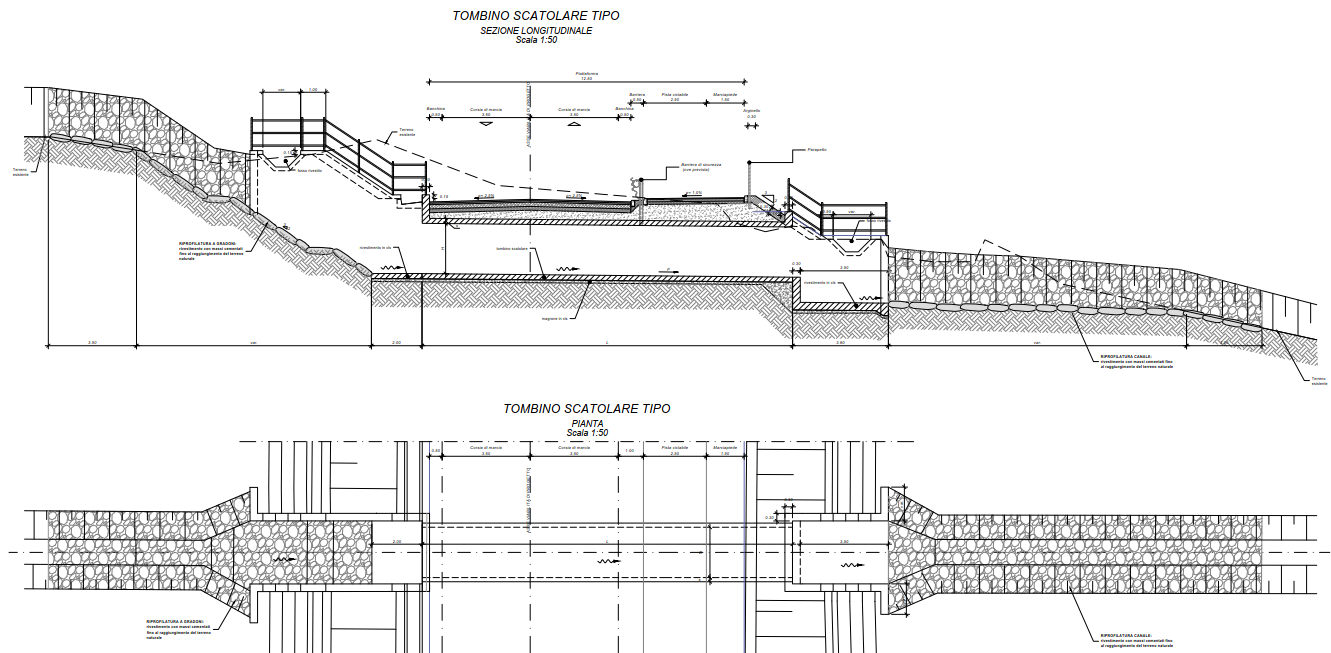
Sezione longitudinale tipologica tombino di attraversamento stradale
